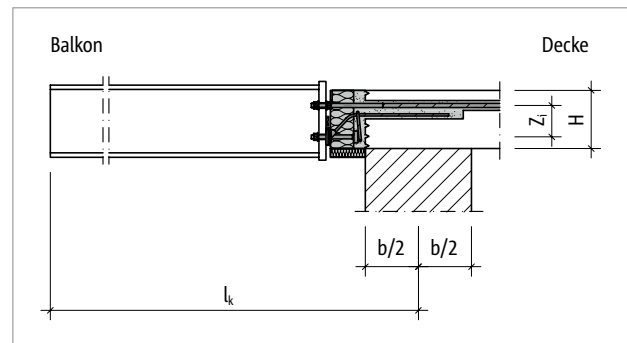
Schöck Isokorb® RT Typ SK: Statisches System; Bemessungswerte beziehen sich auf Wandmitte
